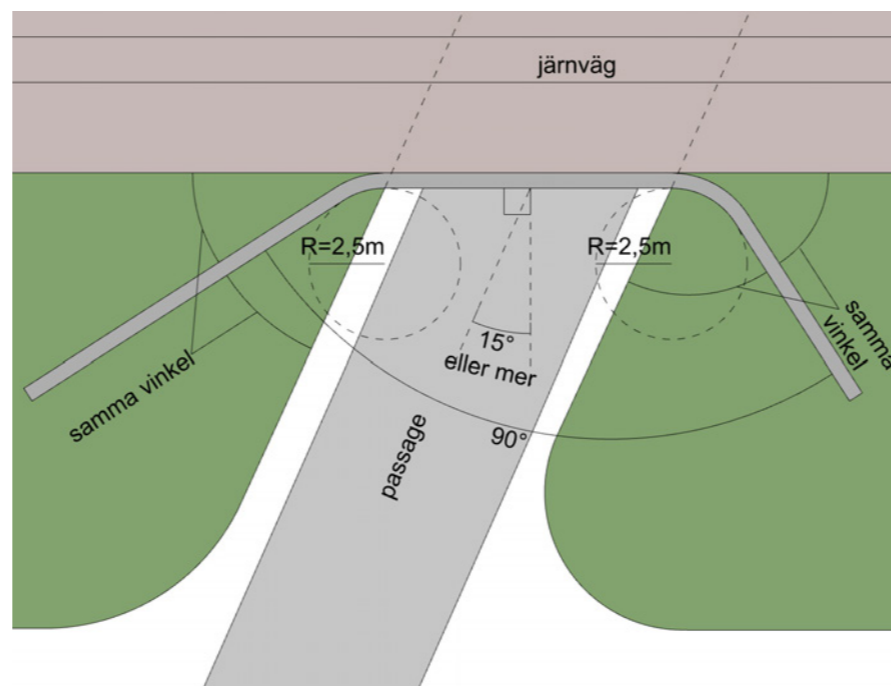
Vägport plattrambro gestaltningsklass 1, placering stängsel i plan.
